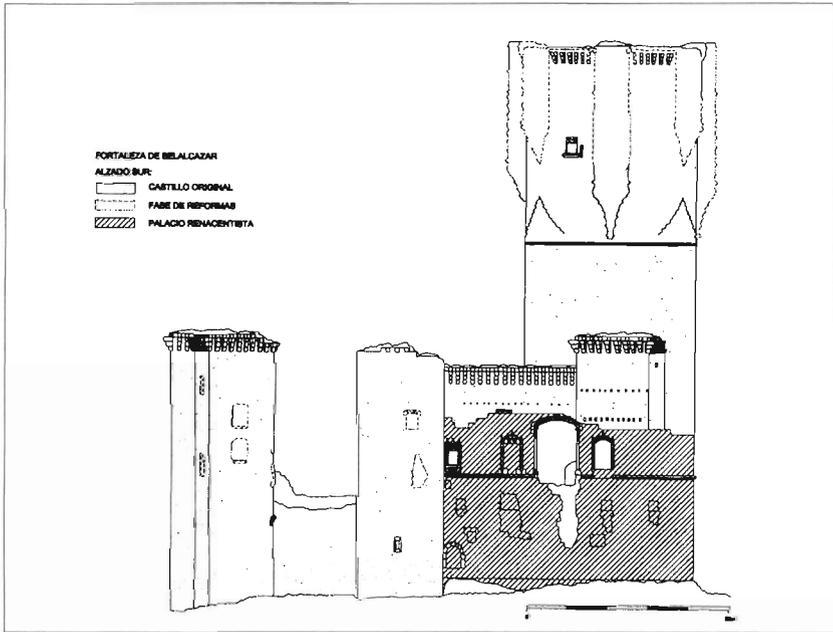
Fortaleza de Belalcázar. Alzado sur.
